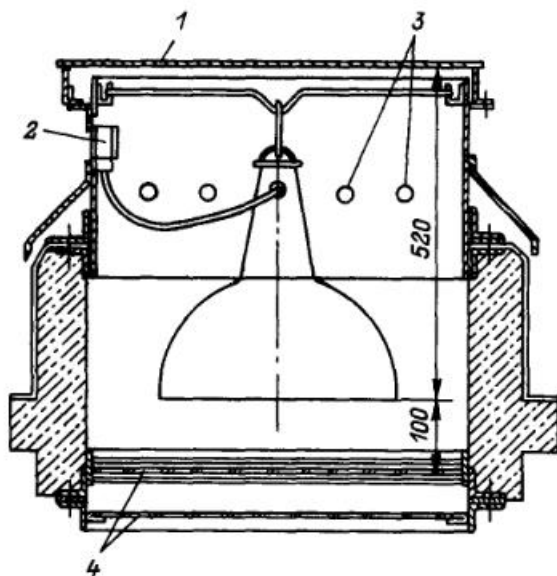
Освещение помещения светильником, установленным в потолочном фанаре
